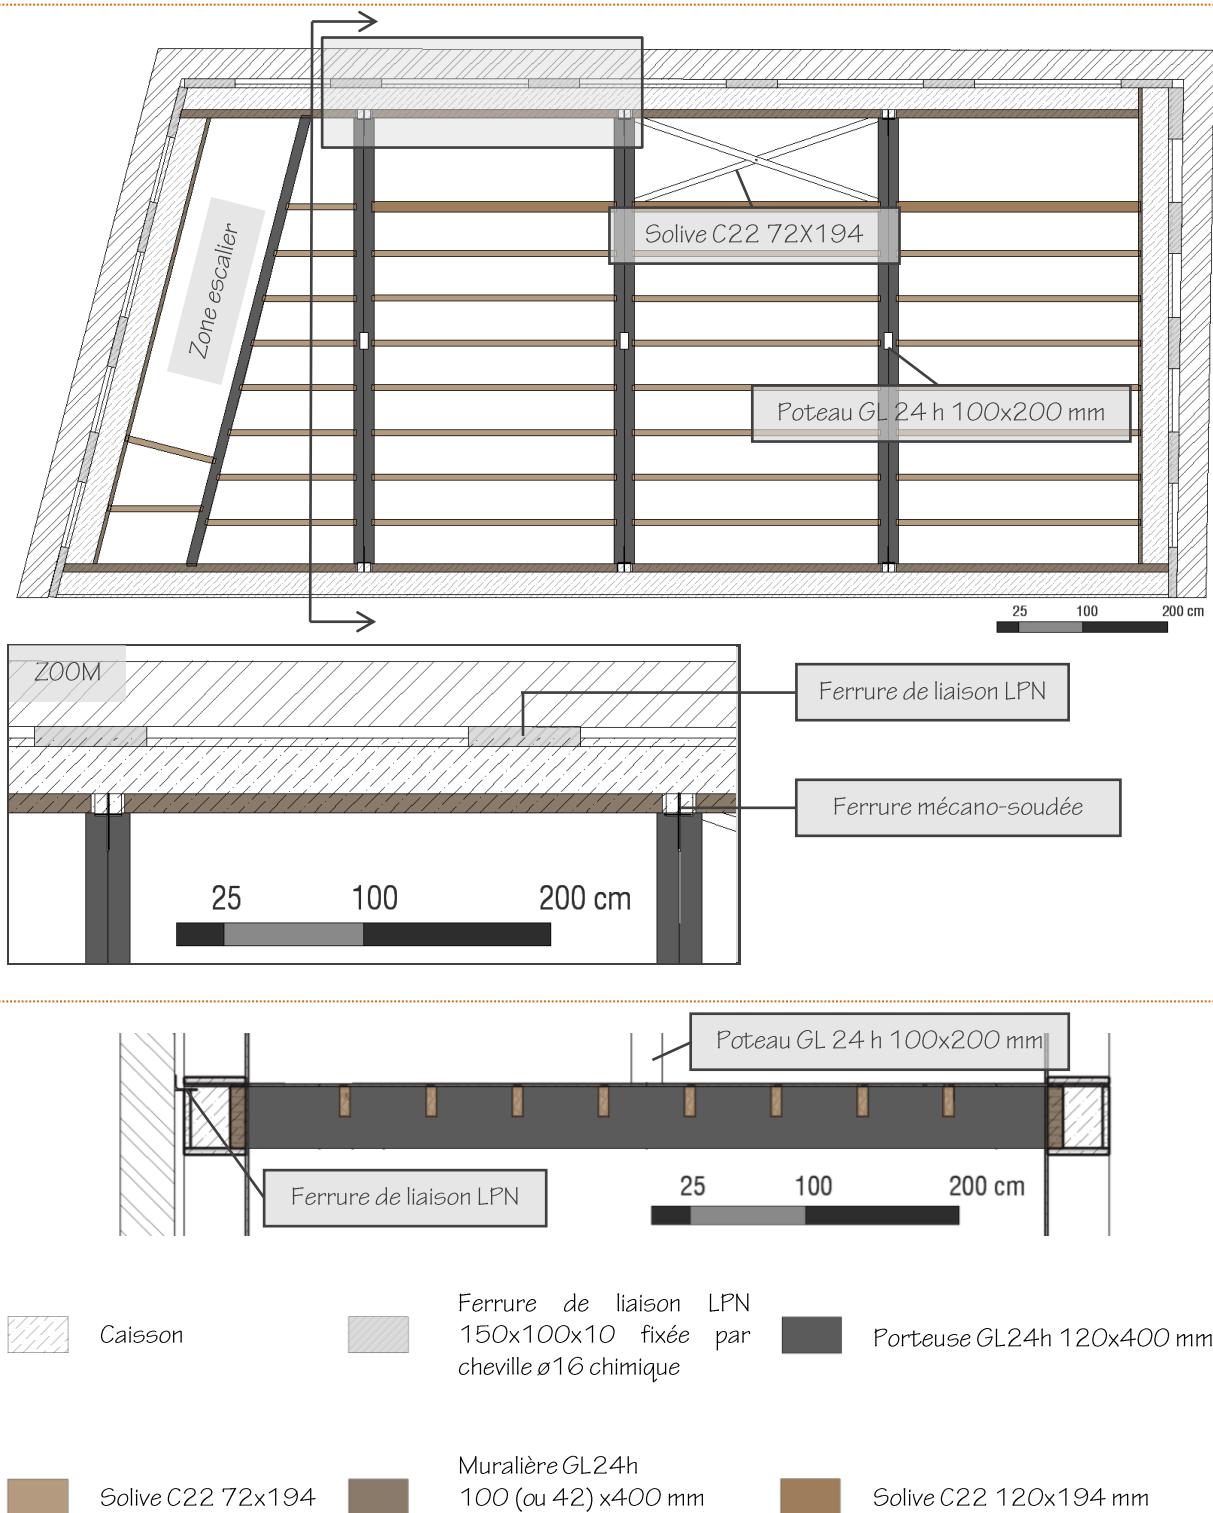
Plan & coupe détail de la structure du plancher, 2<sup>e</sup> étage (Figure réalisée par l'auteur depuis la source : Bureau Modelmo, 2010)
